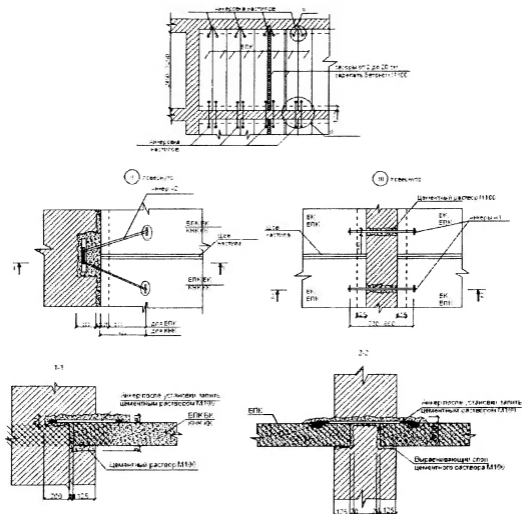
Классификация конструктивных решений железобетонных перекрытий при реконструкции
